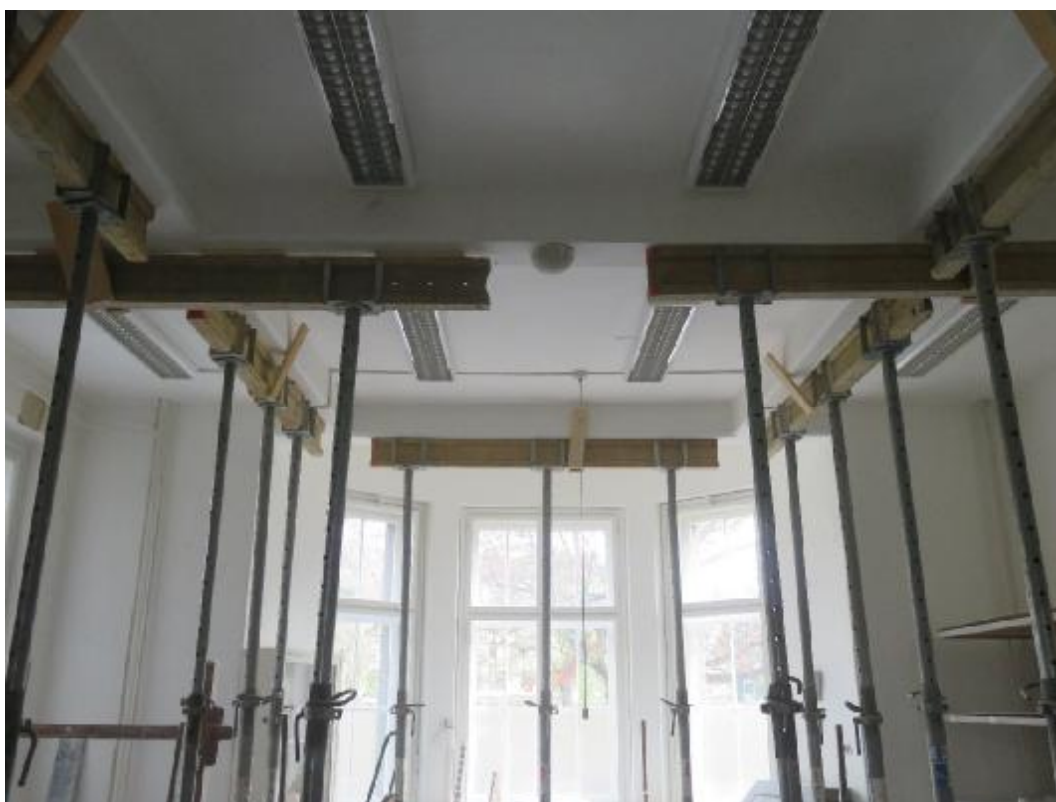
Hlavní budova 1.NP, místnost M3: viditelný průhyb stropní konstrukce cca 30 až 40 mm.
